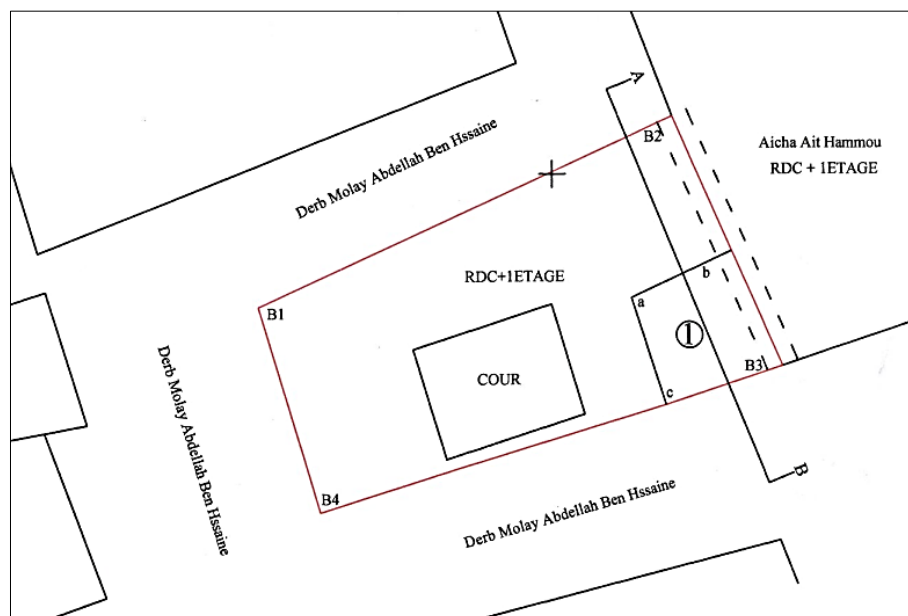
Plan de situation d'une maison grevée de servitude de mur partagé (B2-B3 en hachures) avec le voisin.
